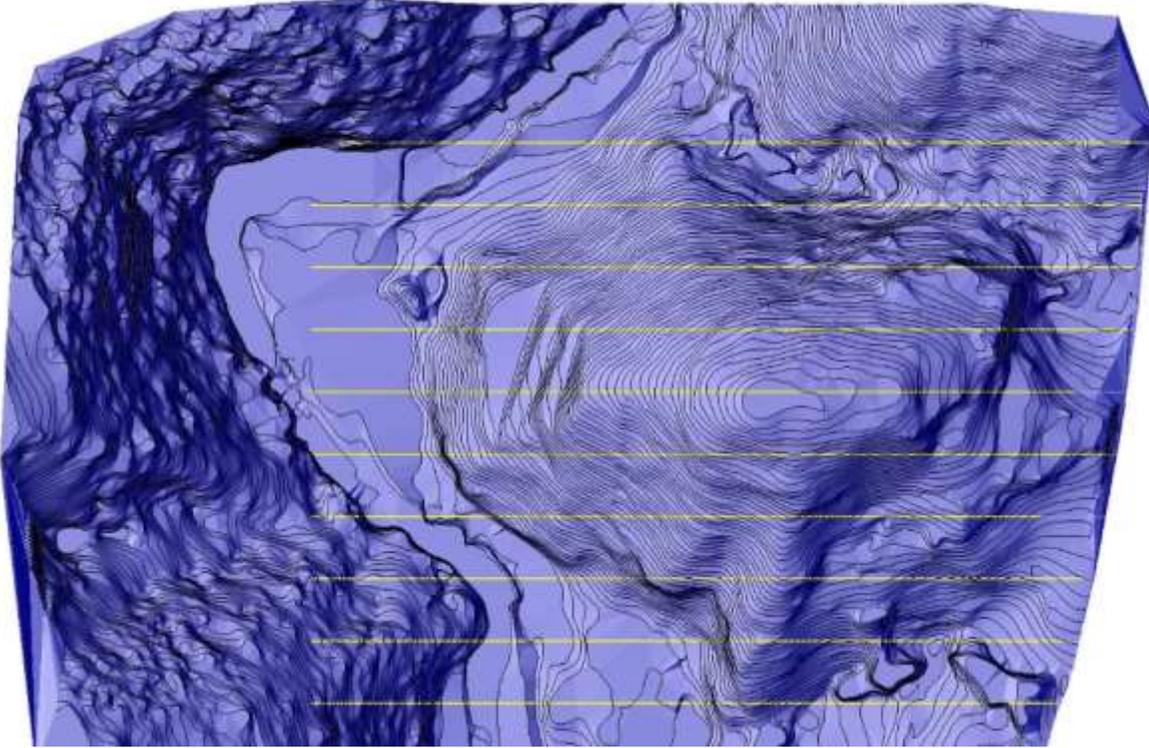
Vista en planta de los perfiles en la zona de preparación
